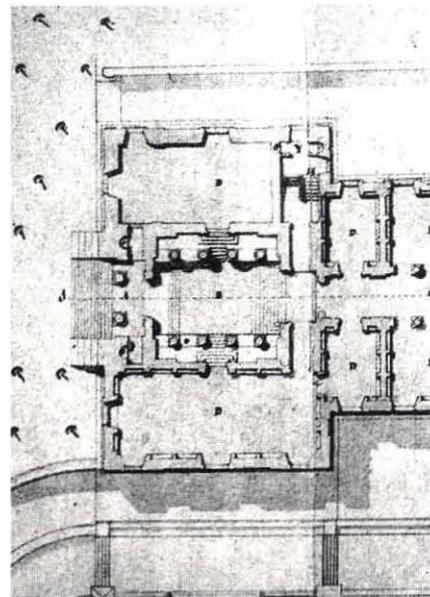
Planta superior del ala norte en el proyecto desechado.
